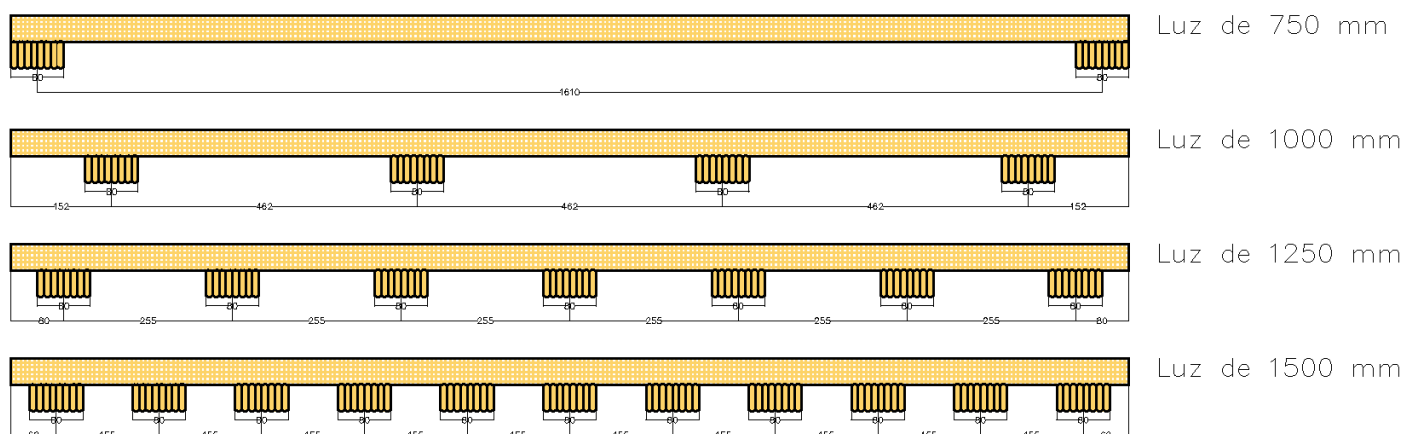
Separación de viguetas para entrepisos y cubiertas (mm).
